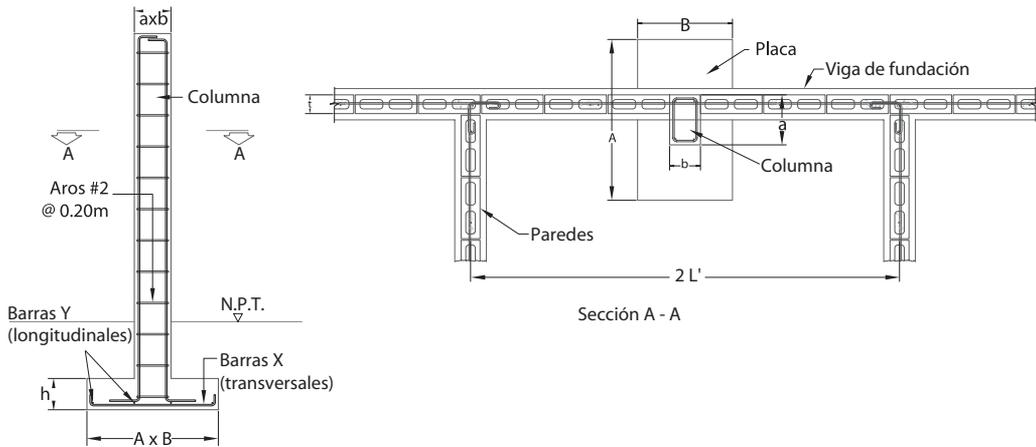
Detalle de columna de concreto reforzado para rigidizar paredes.
